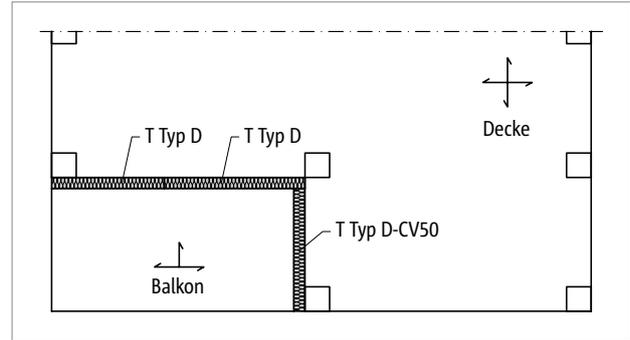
Schöck Isokorb® T Typ D: Einsatz in Flachdecken
